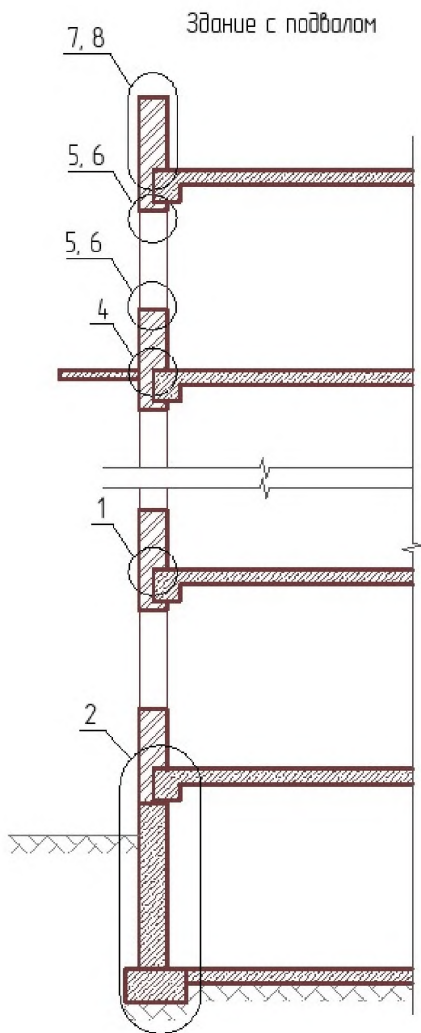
Схема нумерации узлов на поперечном разрезе здания
